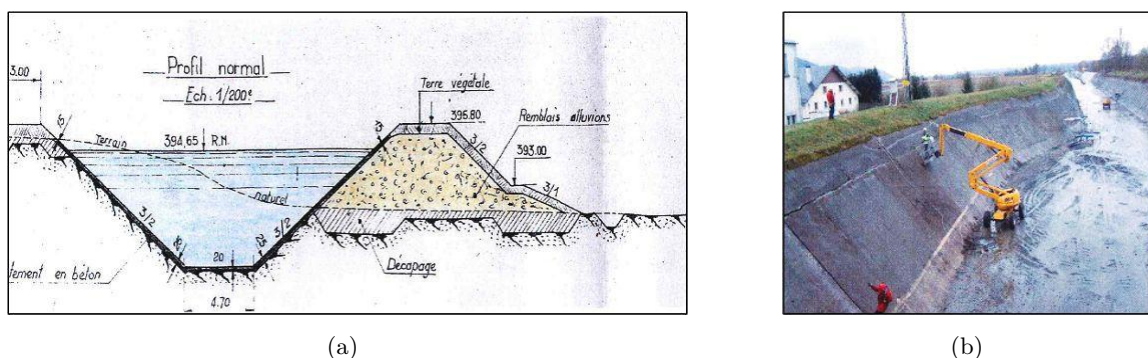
Illustrations 5.1(a) d'une coupe schématique de la composition de l'ouvrage au niveau d'une section en remblai et 5.1(b) des bajoyers au niveau d'un BMC.
